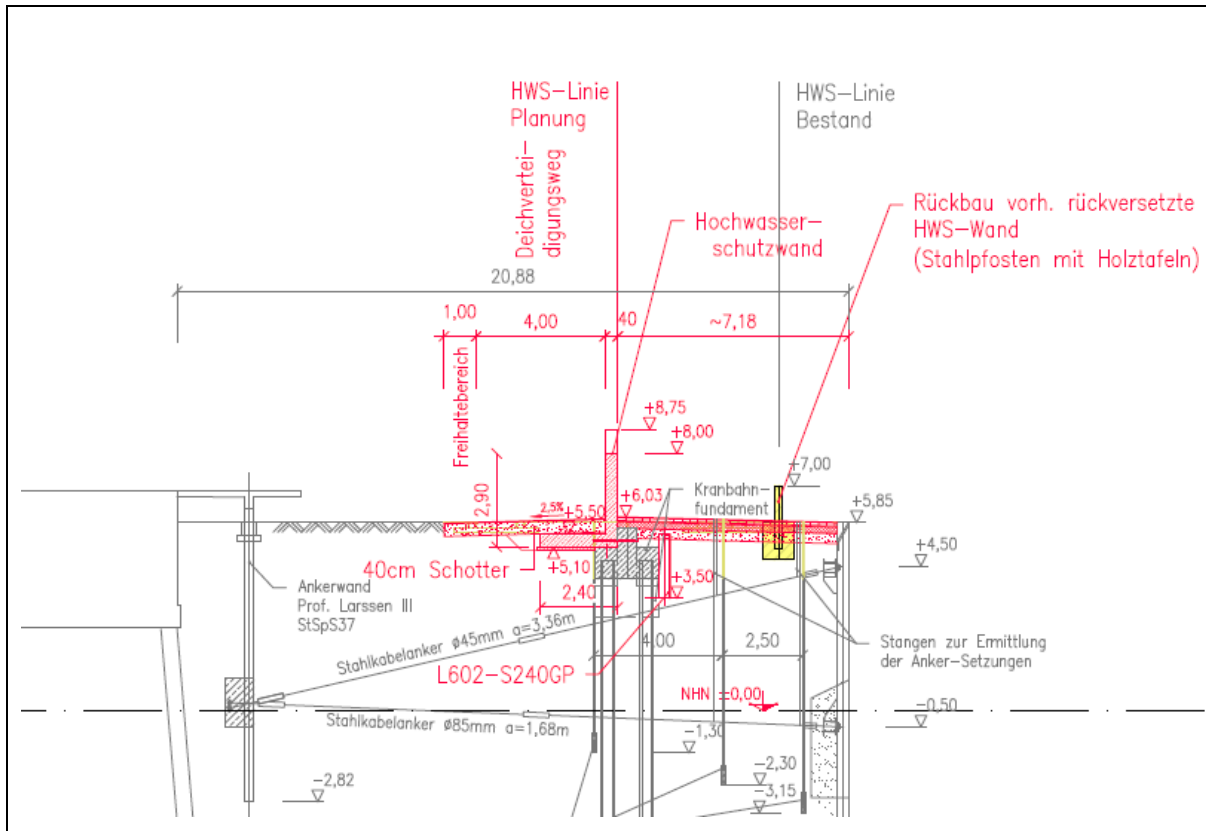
Querschnitt HWS-Anlage - Gründung auf Pfählen Kranbahnbalkenfundament
